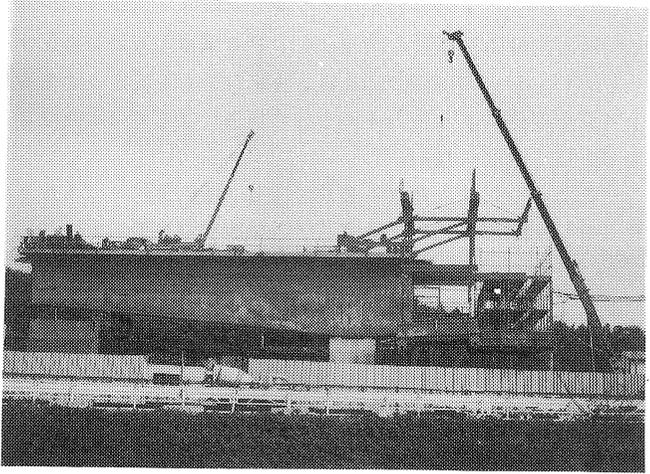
P1からの張り出し施工（ワーゲン組立状況）
